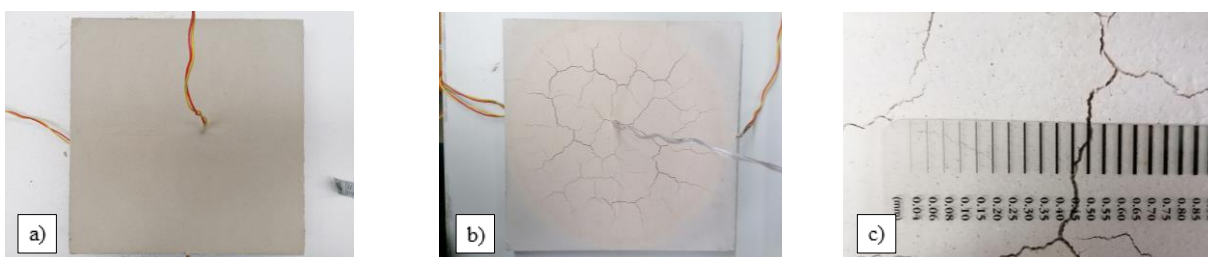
Provete P_A4_1_LA: a) Provete antes do ensaio; b) Provete após o ensaio; c) Fissuração do provete após o ensaio.
